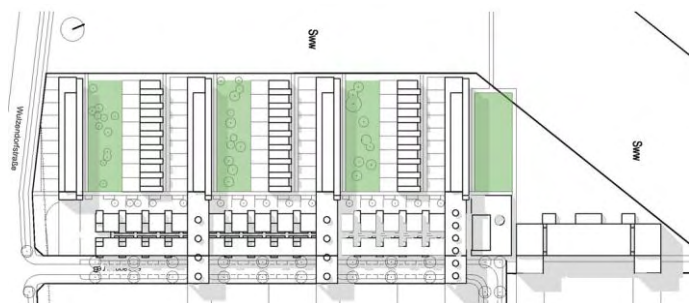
Lageplan, bearbeitet (Arch. Walter Stelzhammer)
